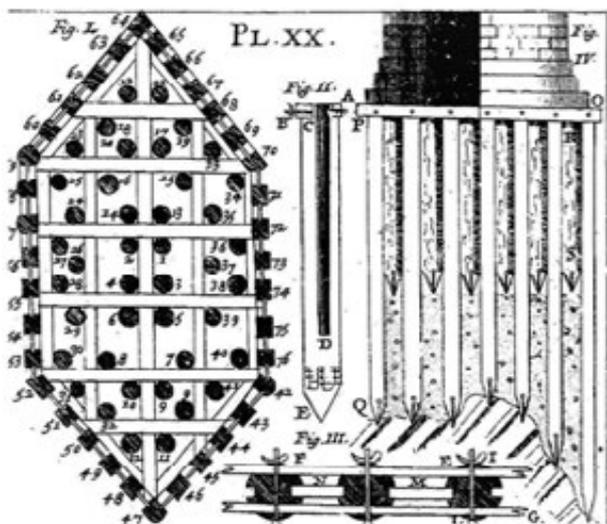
Fondation sur sol renforcé par un pilotis de pieux battus (extrait *Traité des ponts* - Gauthey 1756)
